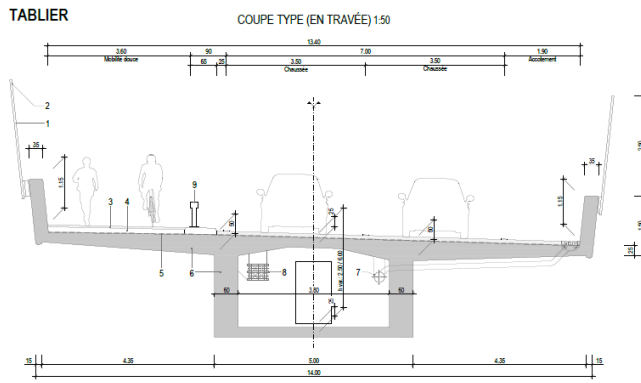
Pont d'Hauterive (extraits planche du concours - GVH)
